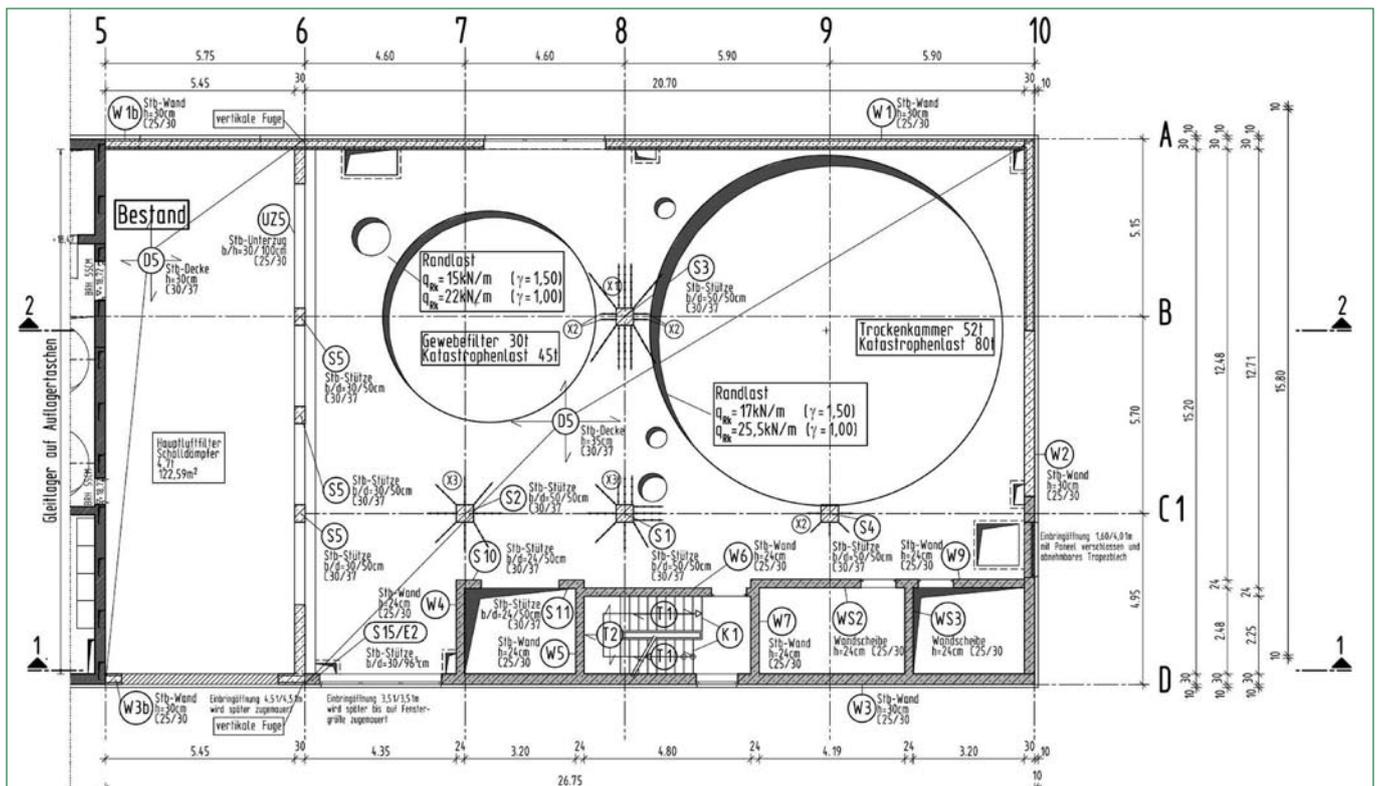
Decke über 3. OG mit sehr großen Aussparungen
